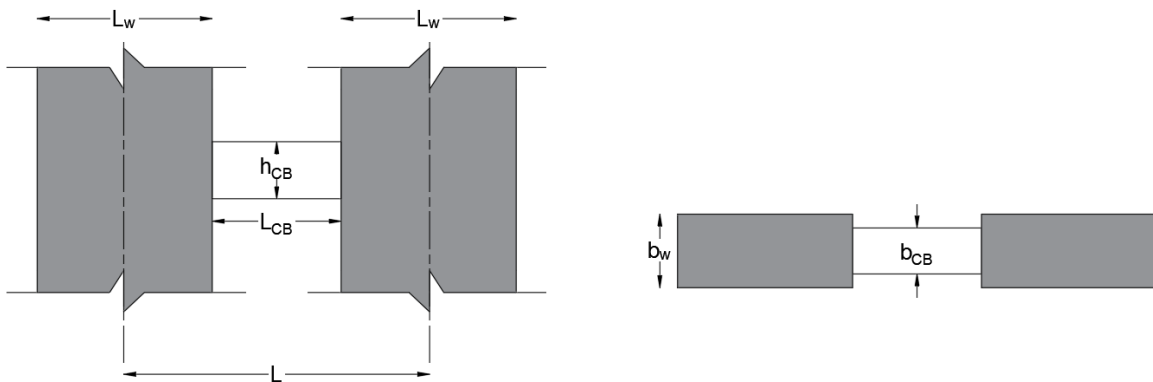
Esquema en elevación y en planta de la geometría de vigas y muros de acople.
